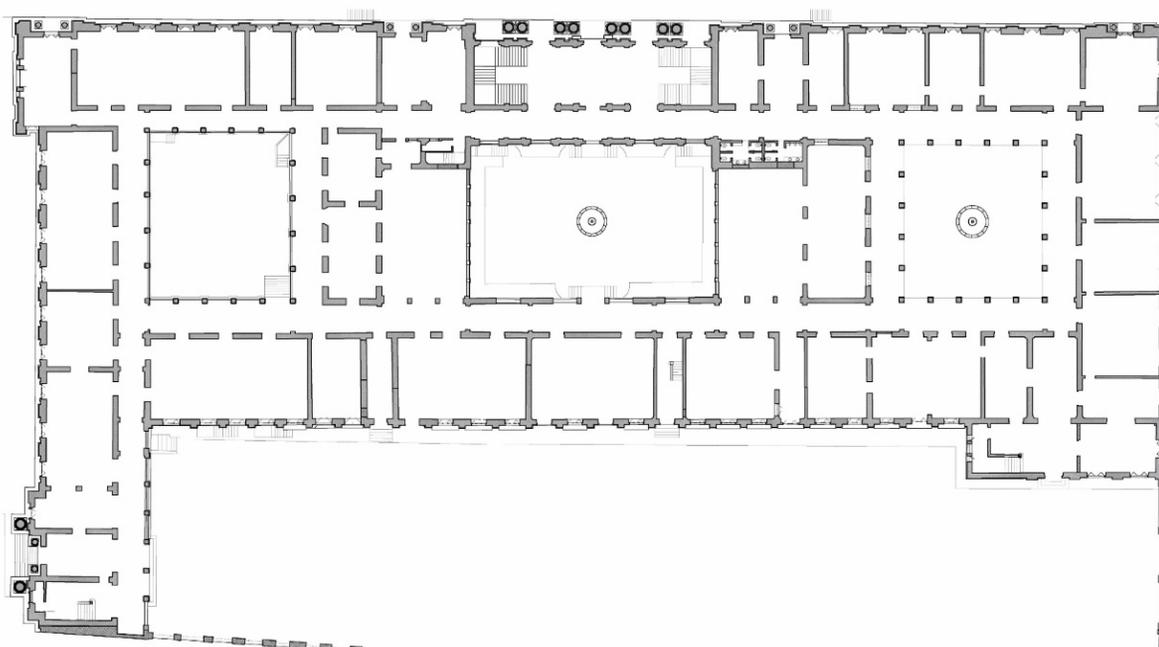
Planta de primer Segundo piso con circulaciones y accesos
